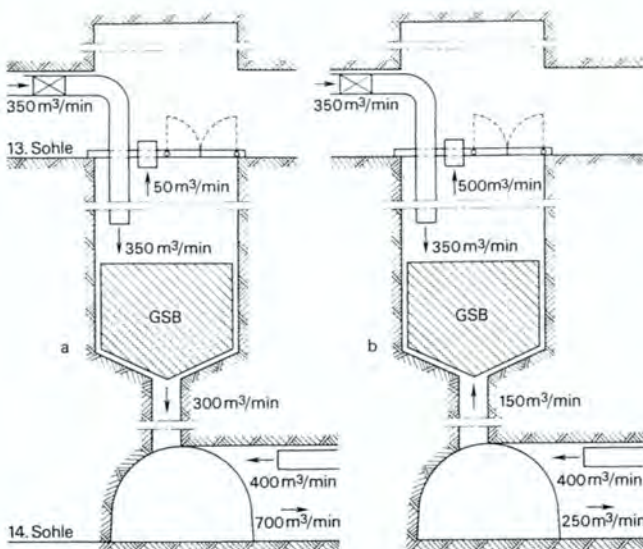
Wetterführung im Bohrblindschacht bei Betrieb (a) und Stillstand (b) der Gesenkbohrmaschine.
